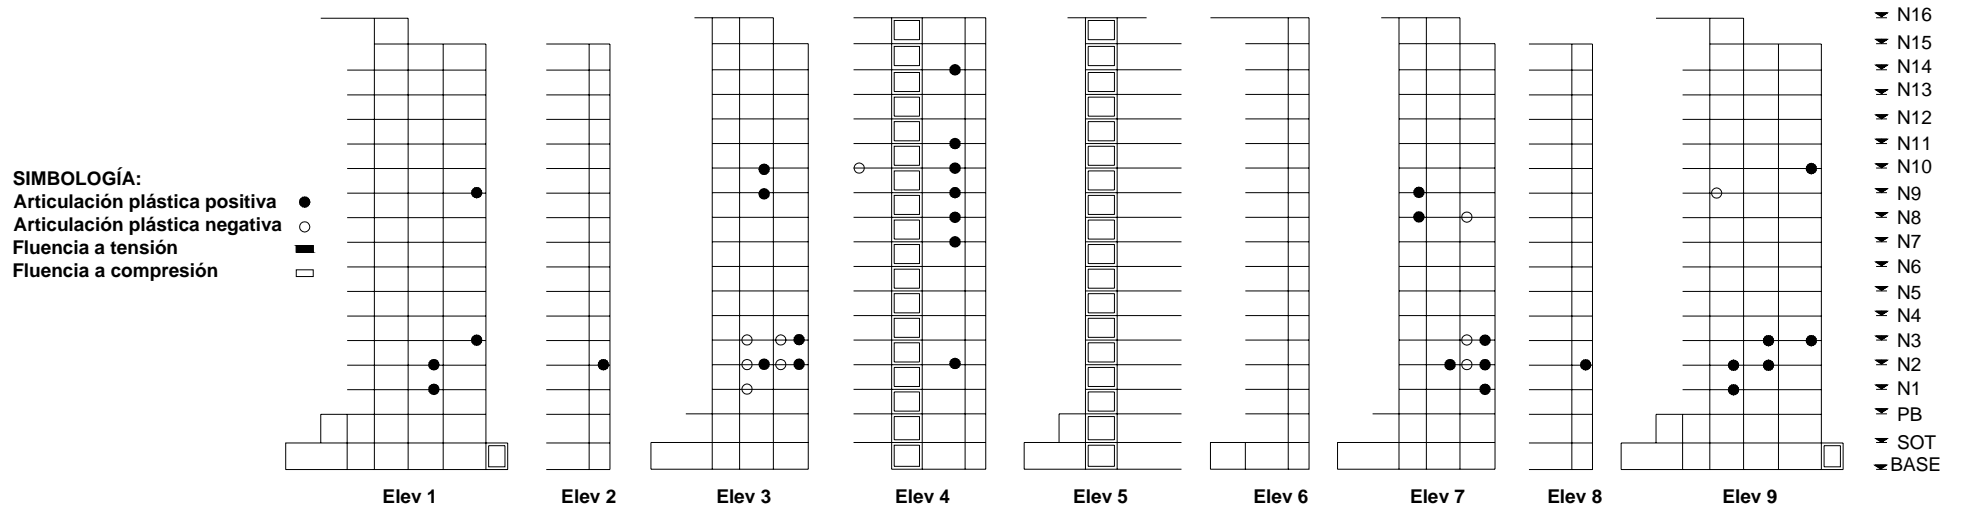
Formación de articulaciones plásticas en vigas y columnas para la SIM81 a los 63.26 s
